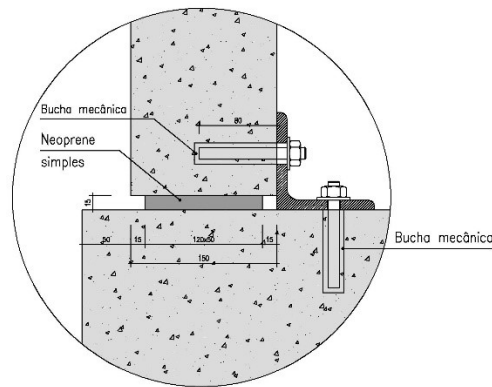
Pormenor de fixação dos degraus à viga de bancada (pormenor 3, Figura 4.8b).
